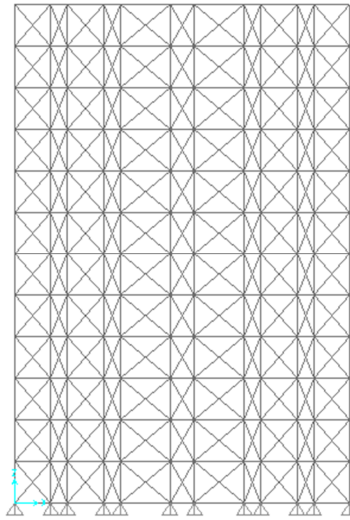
Configuração dos Planos de Contraventamento Vertical Com Elementos de Contraventamento Pequenos
